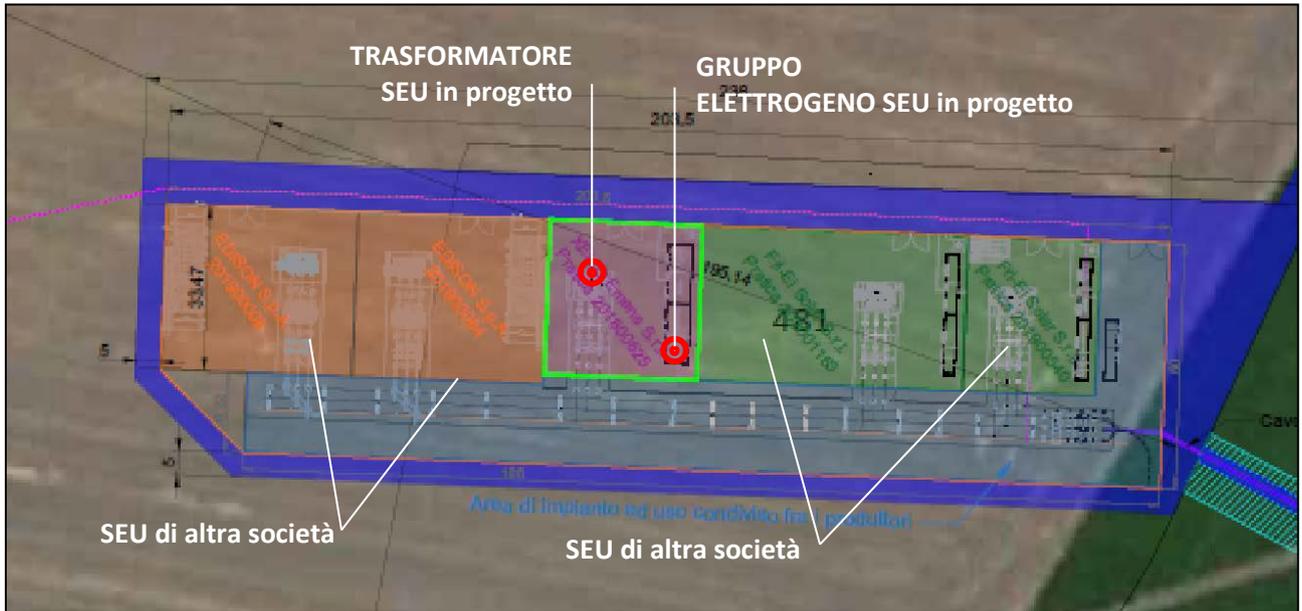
stralcio elaborato di progetto STAZIONE UTENTE
